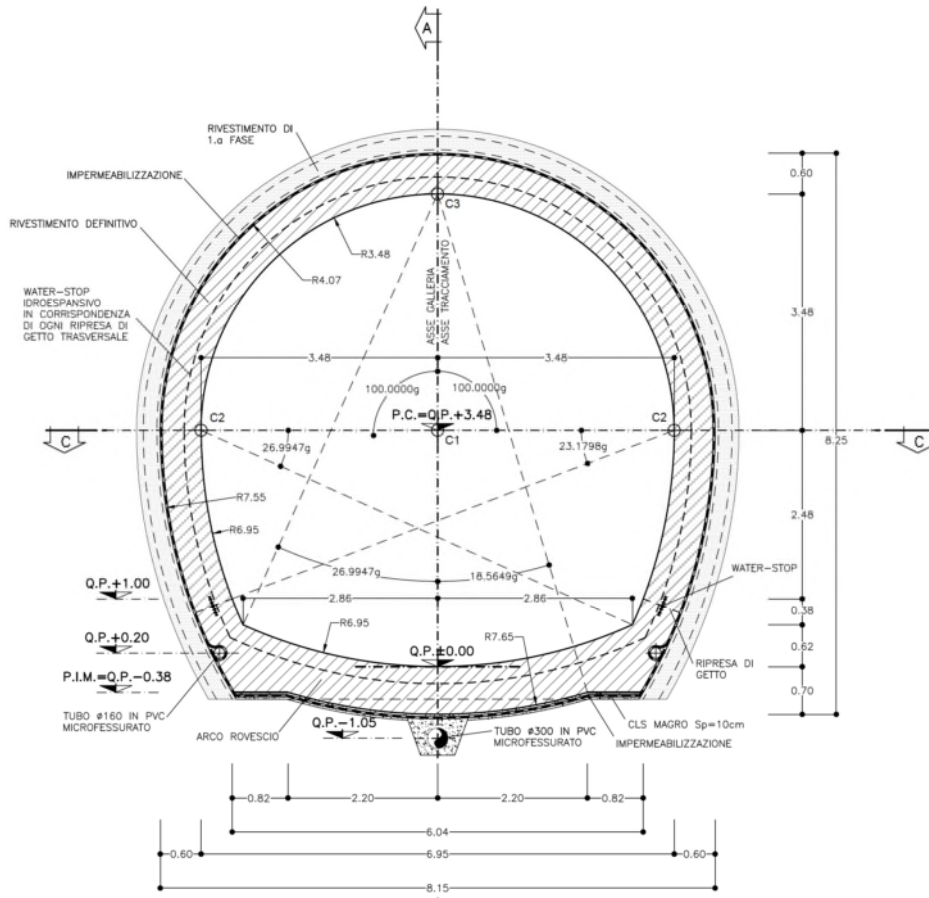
Sezione Tipo B0 – Carpenteria – Sezioni
